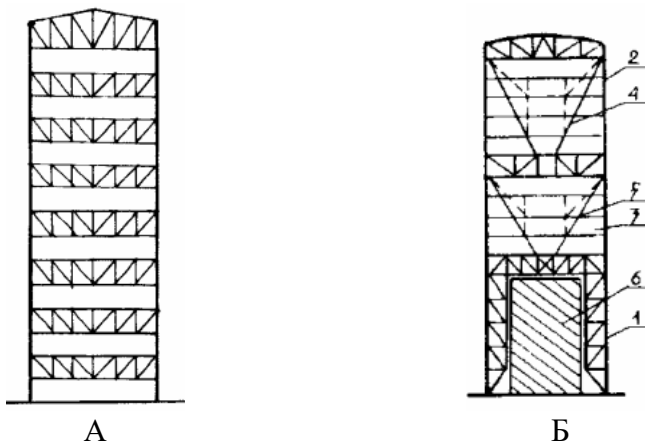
А – сталевий каркас багатоповерхової будівлі без внутрішніх колон; Б – поперечні сталеві рами будівлі, в яких здійснюється реконструкція з надбудовою поверхів (до 15 поверхів); 1 – нижня секція рами; 2 - верхня секція; 3 – середня секція; 4 – елементи жорсткості; 5 – підвіски; 6 – існуюча будівля, яку надбудовують.
